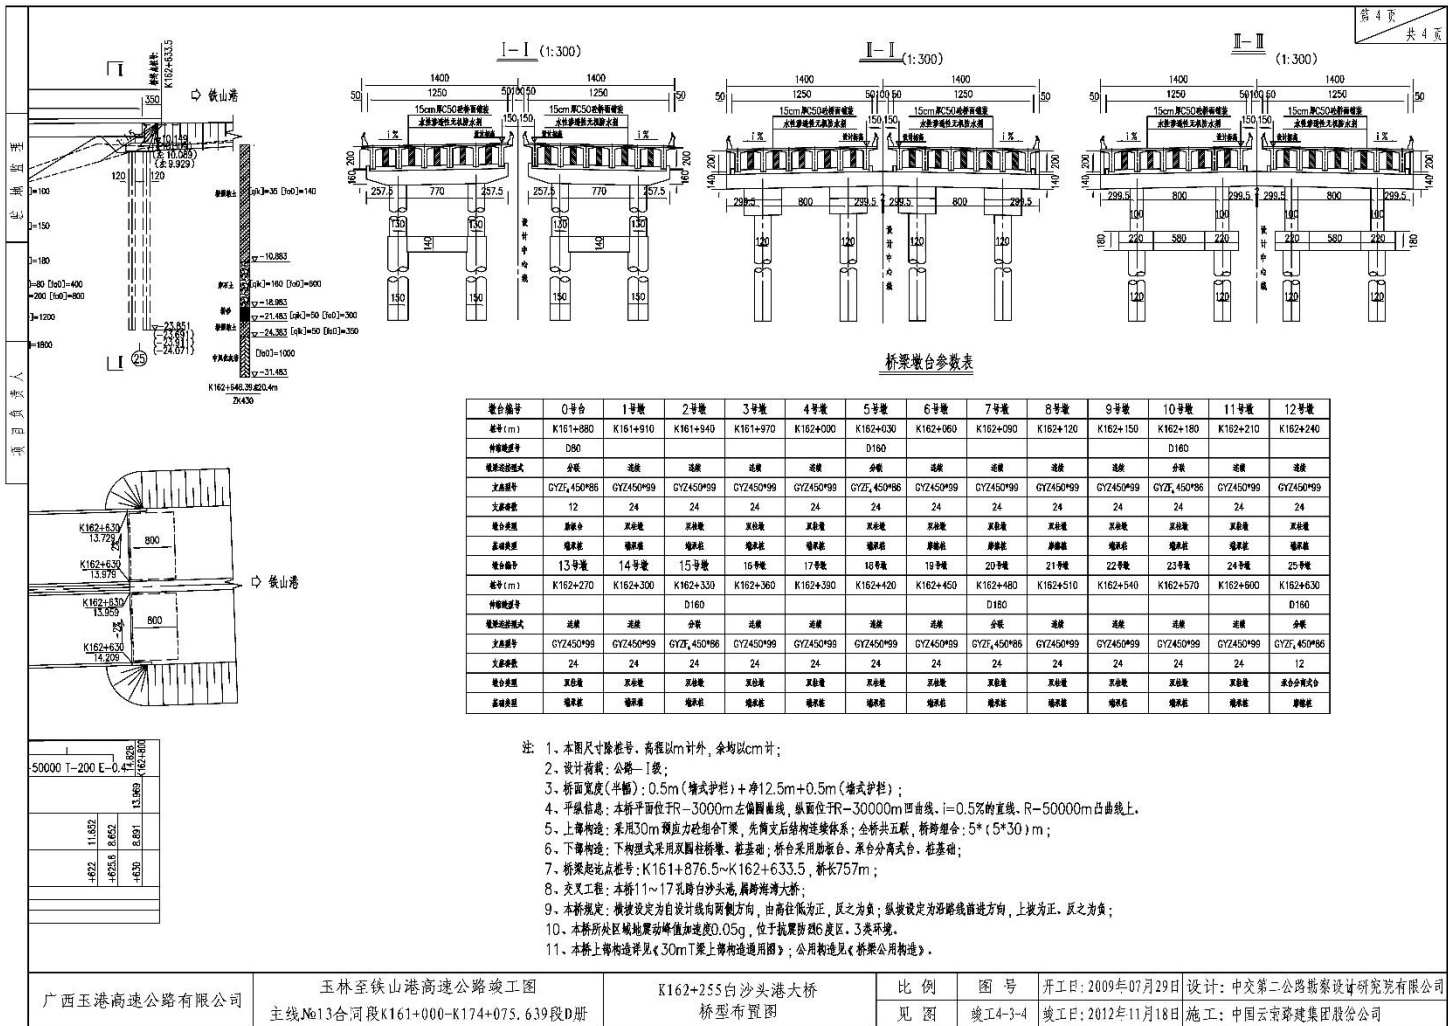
(4) 白沙头港大桥总平面布置图-分幅 4
